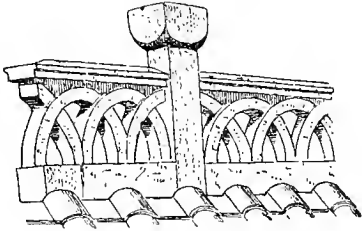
Crête de toiture en pierre à Cavaillon (Vaucluse).
